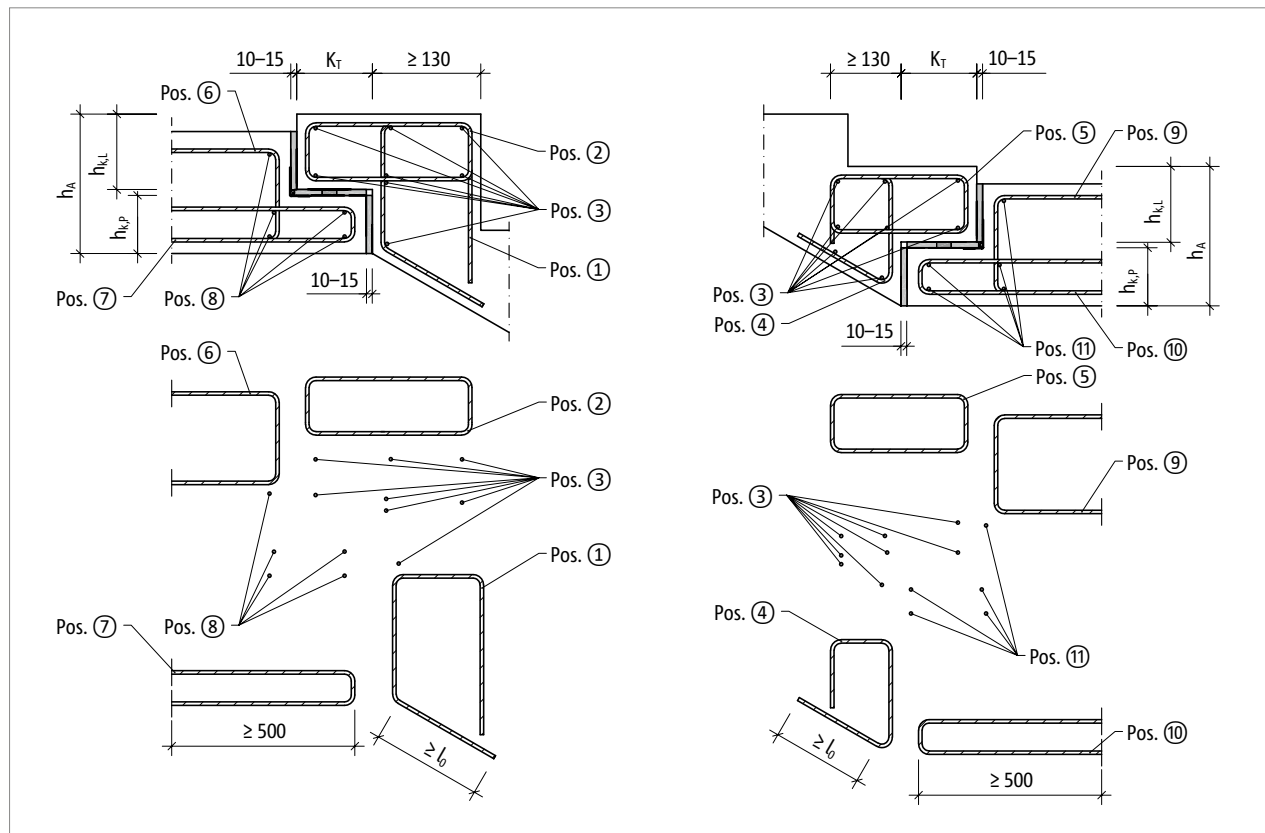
Tronsole® F: bauseitige Bewehrung bei überhöhtem Anschluss
